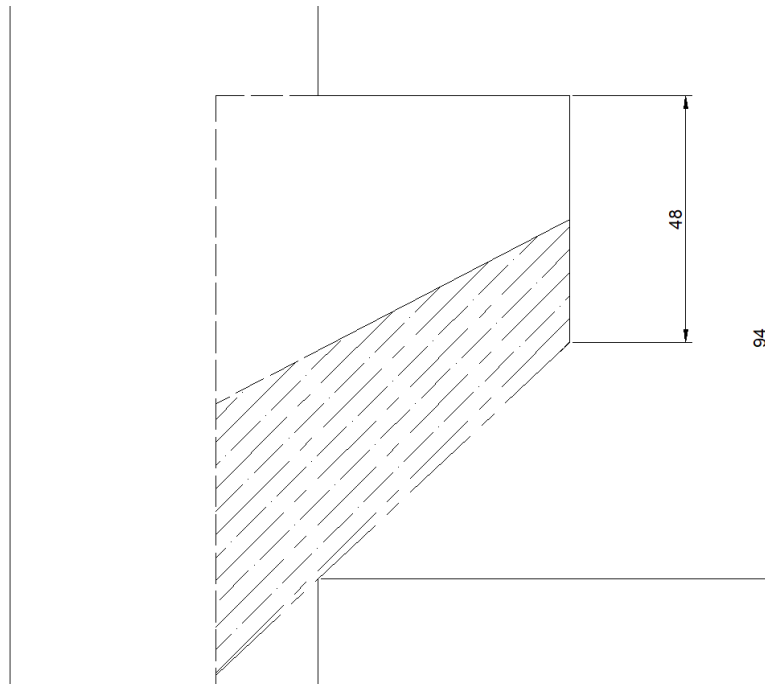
Alternativa de refuerzo 2. Vista en alzado.
